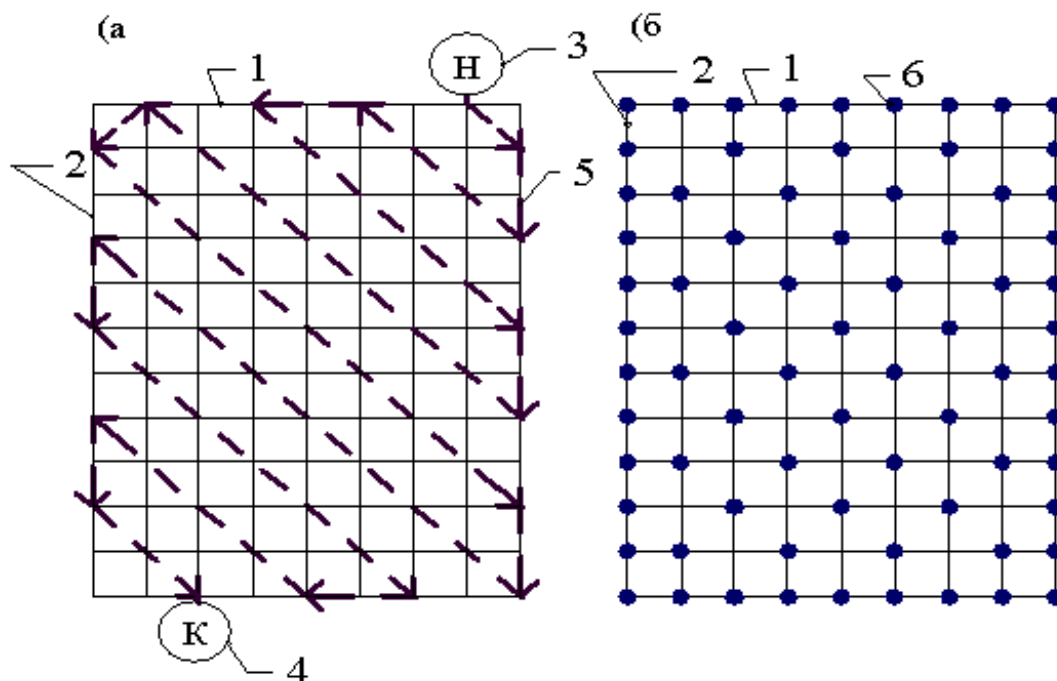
Порядок закрепления арматурных стержней вязальной проволокой: а) схема движения рабочего вяжущего пересечения стержней; б) схема закрепления стержней арматурной сетки: 1 – поперечные стержни; 2 – продольные стержни; 3 – начало пути рабочего; 4 – окончание пути рабочего; 5 – путь движения рабочего; 6 – пересечение арматурных стержней, закрепленное вязальной
